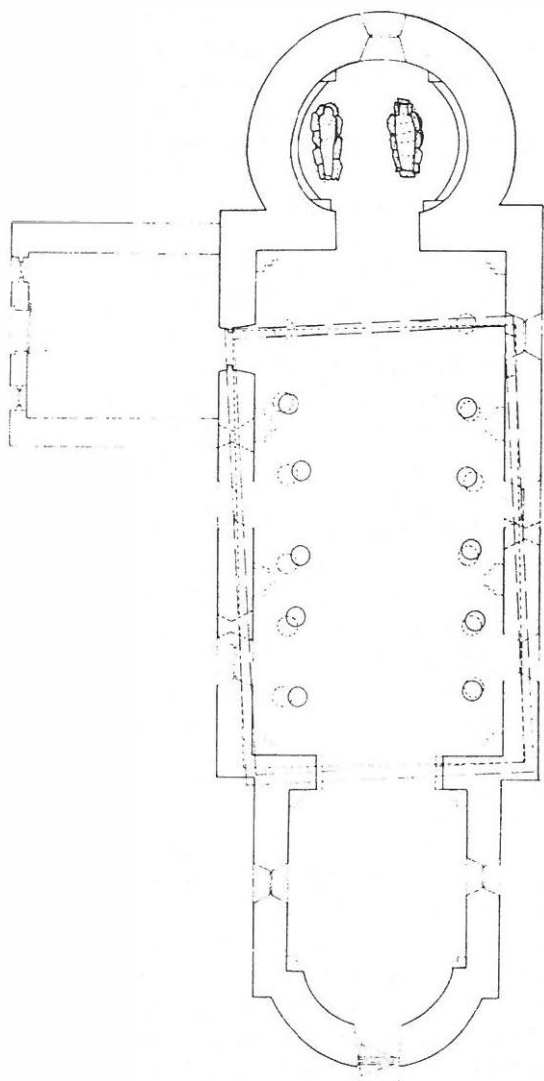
Grundriß der Kirche zu Hammerlund in Schonen mit zwei zeitgleichen "Stiftergräbern" im runden Westturm (um 1150). Außerdem sind die ergrabenen Spuren zweier älterer Holzkirchen eingetragen. Nach E. Gustafson – M. Weidhagen, *Investigations in Hammarlunda Church*, *Res Medievals* Lund 1968.
